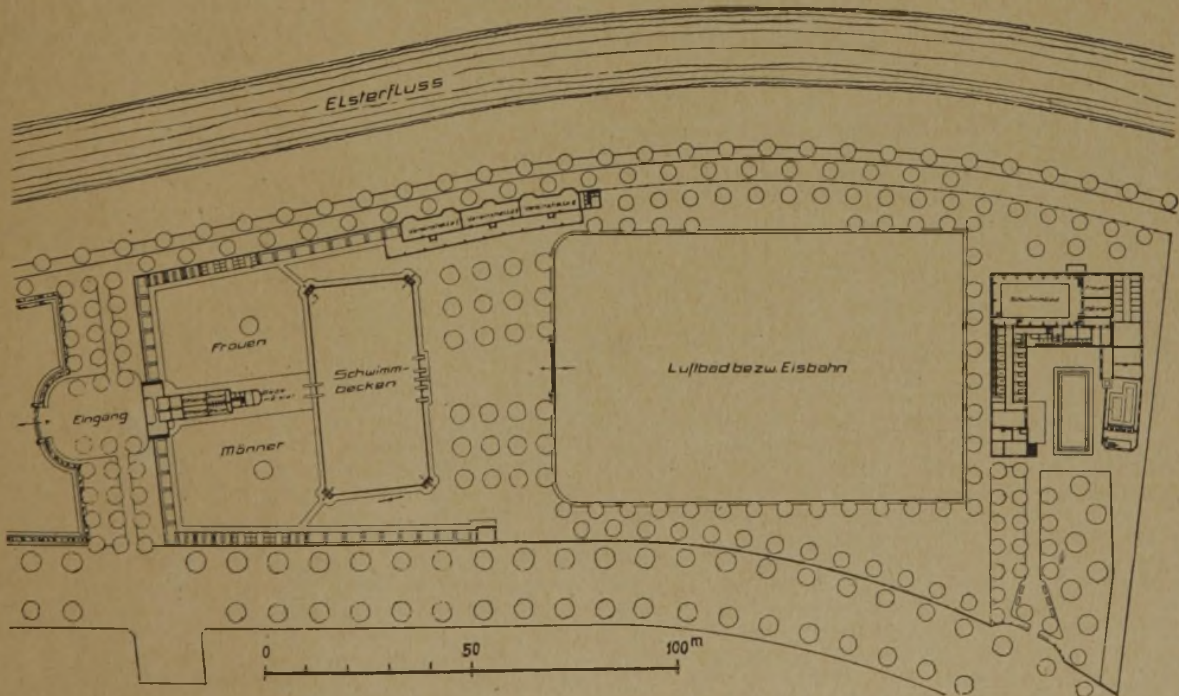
Teillageplan mit Grundrißeinteilung. (rd. 1 : 2000).
